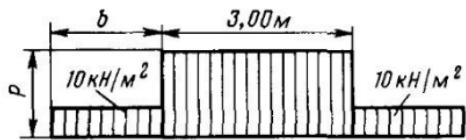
Вертикальная нагрузка на призме обрушения от транспортных средств
